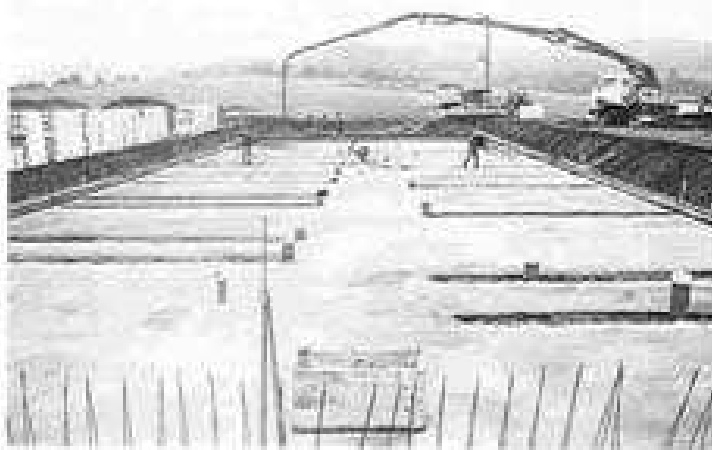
Die Bodenplatte des Stalles wird betoniert, die Rohre für das Entmistungssystem werden bereits eingebaut.
